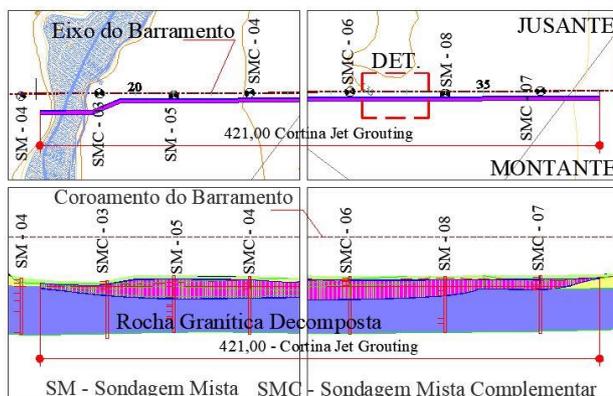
Cortina de Vedação – planta e perfil longitudinal
